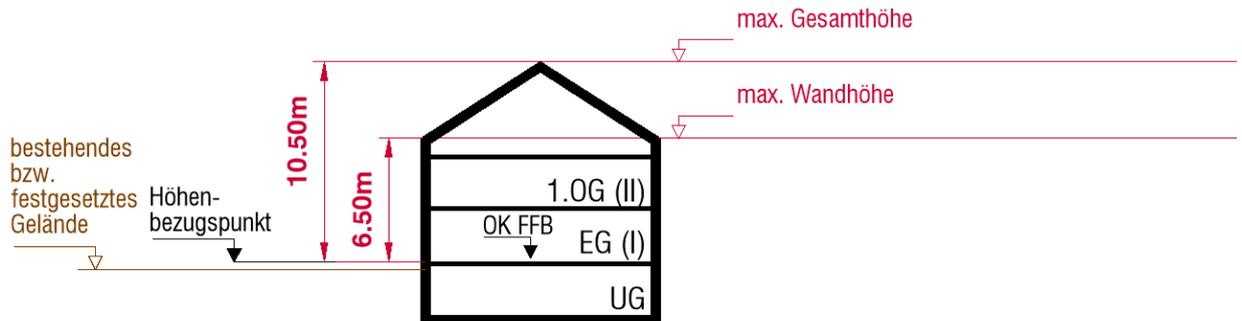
Beispielhafte Systemskizze für ein Gebäude mit Sattel- oder Walmdach im WA 1, o. M.
